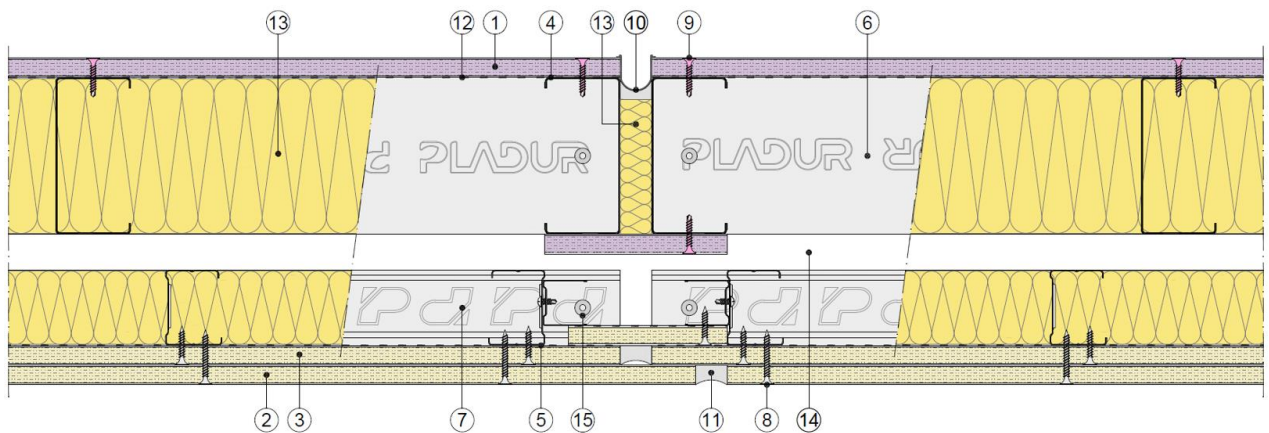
Encuentro con forjado en el sistema doble y detalle de fijación perimetral de placas.
